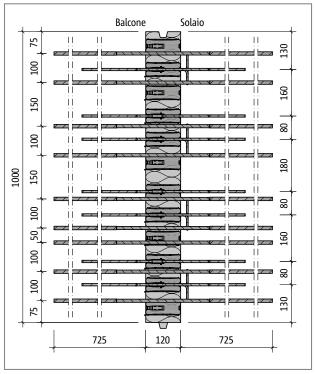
Schöck Isokorb® tipo KXT45-VV: sezione dell'elemento
